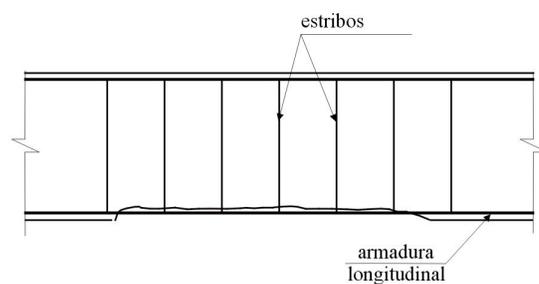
Exposição de armaduras devido a falhas de concretagem
